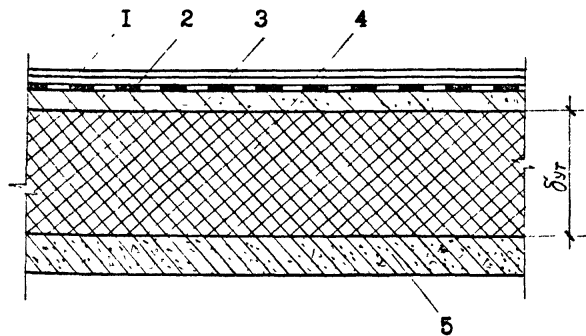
Конструктивная схема железобетонного покрытия
